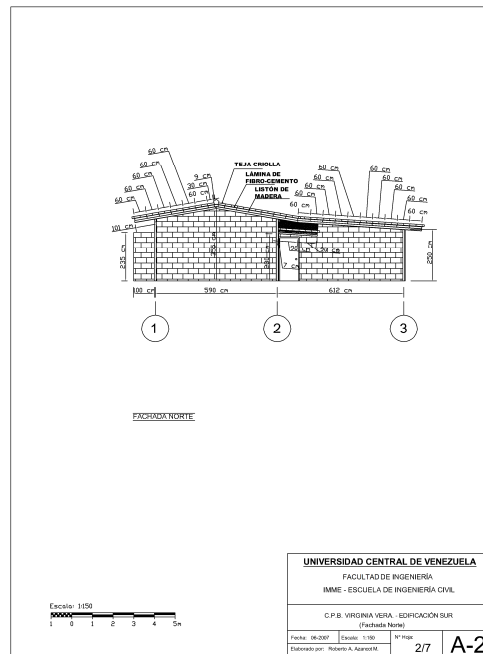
Plano A2: Plano Arquitectónico de la Fachada Norte
